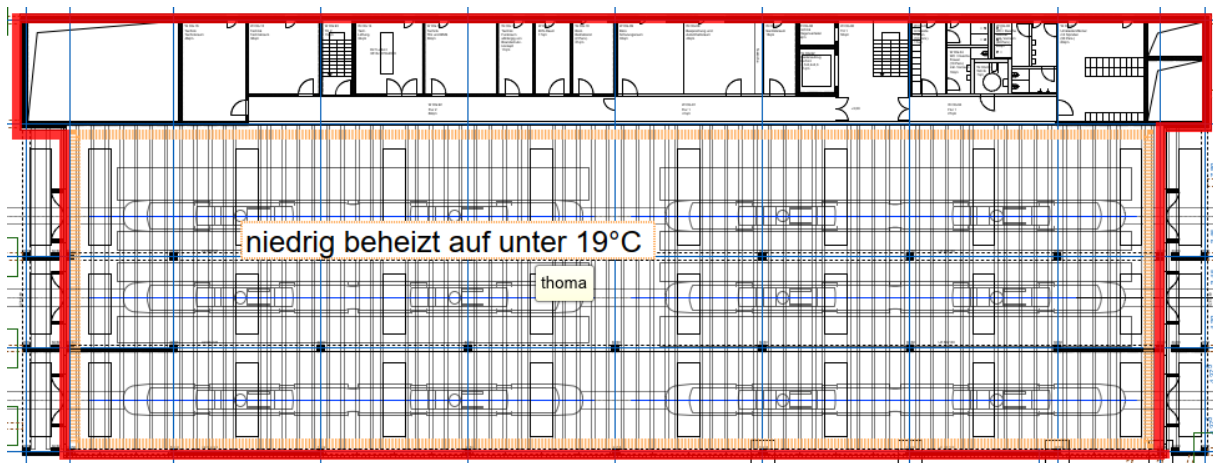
Grundriss thermische Hülle OG, Wasch-/Wartungshalle
